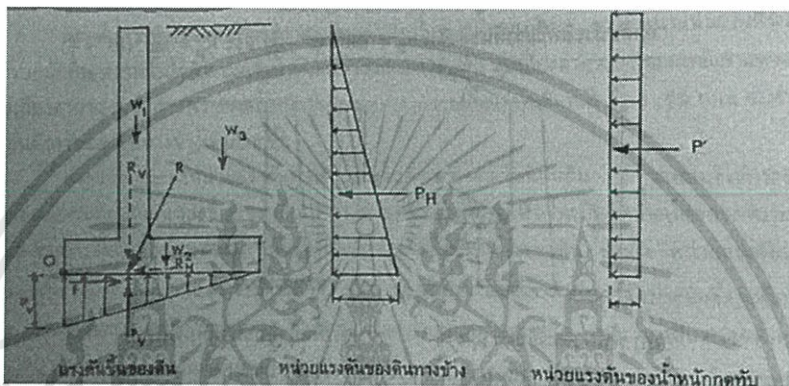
ผนังคอนกรีตกันดิน (Retaining Wall)
